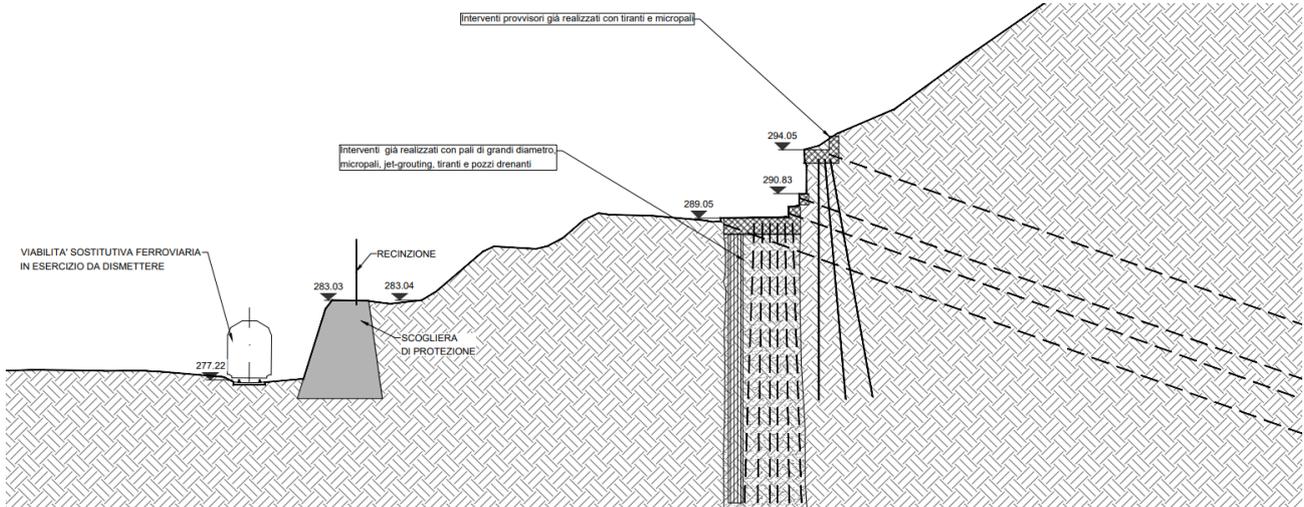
Situazione ante operam – Sezione DD (vedere elaborati di progetto allegati)
